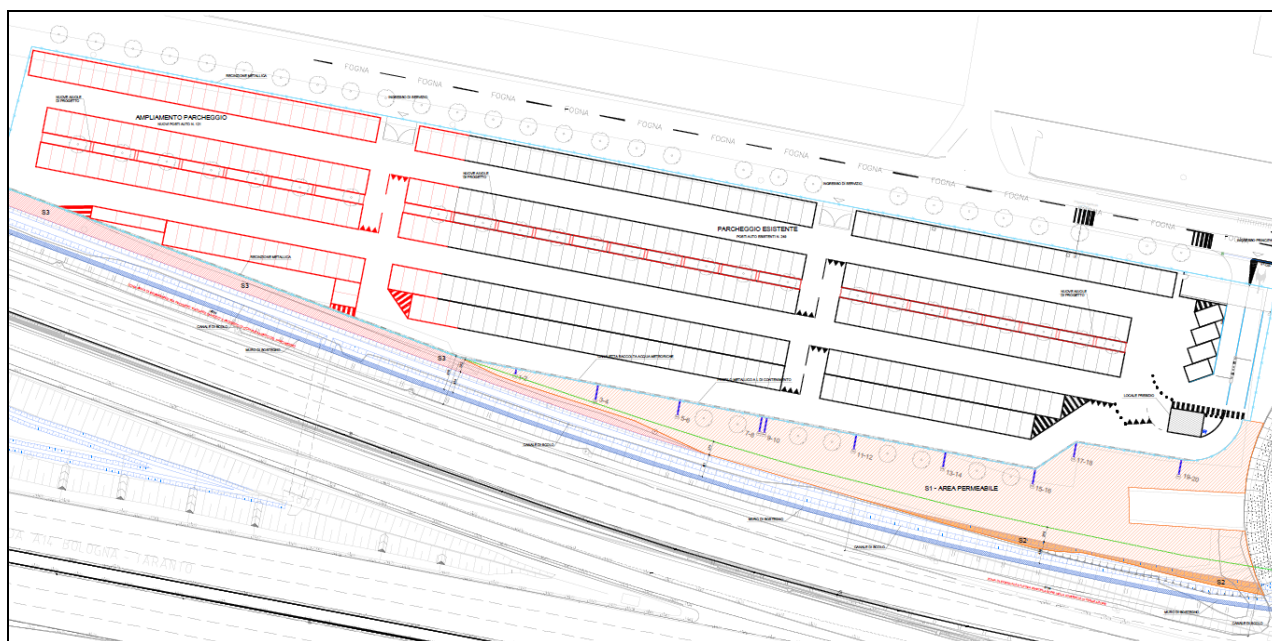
stralcio Tav. EA03: sovrapposizione progetto parcheggio e progetto Autostrade – planimetria
